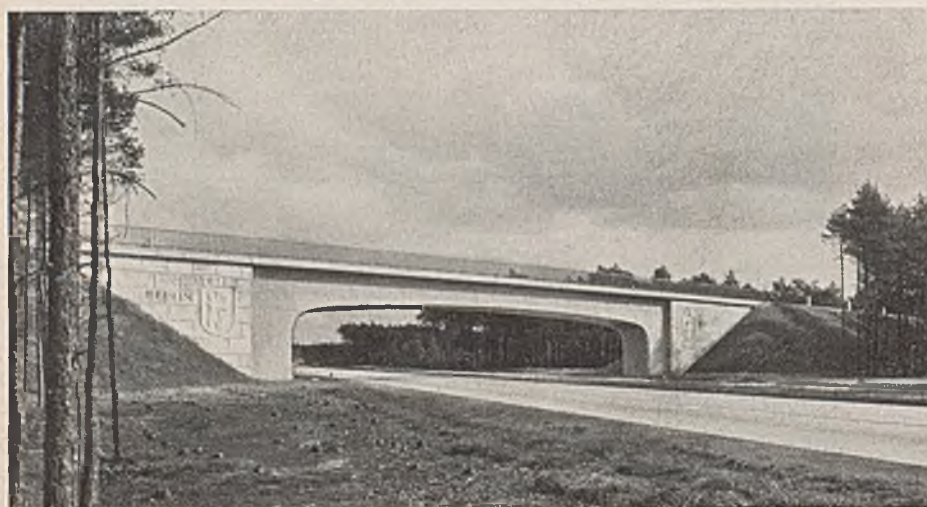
Eisenbetonrahmen mit Parallelfügeln.
